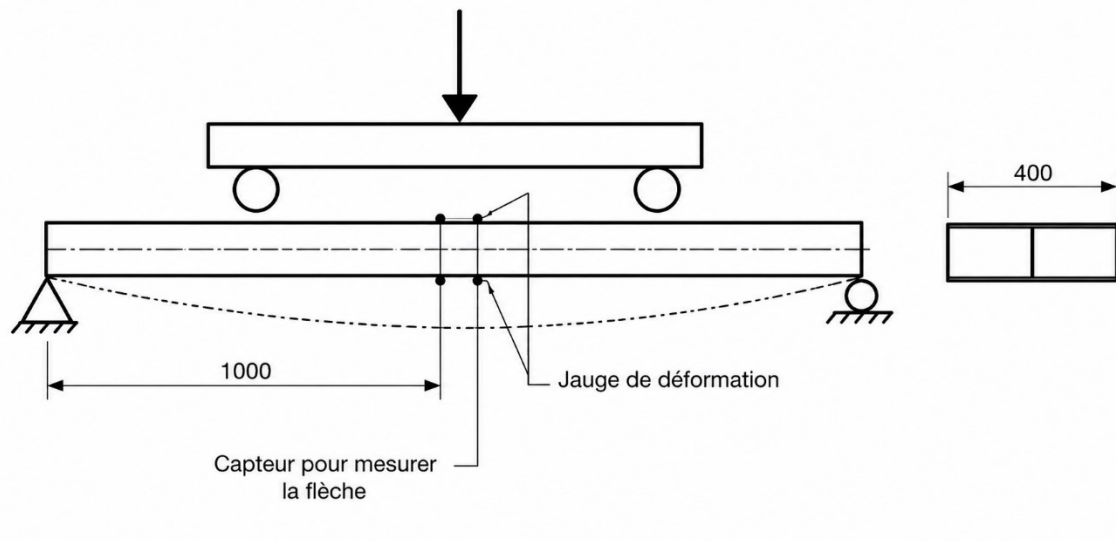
Schema typique illustrant le chargement d'une poutre en flexion 4 points.
